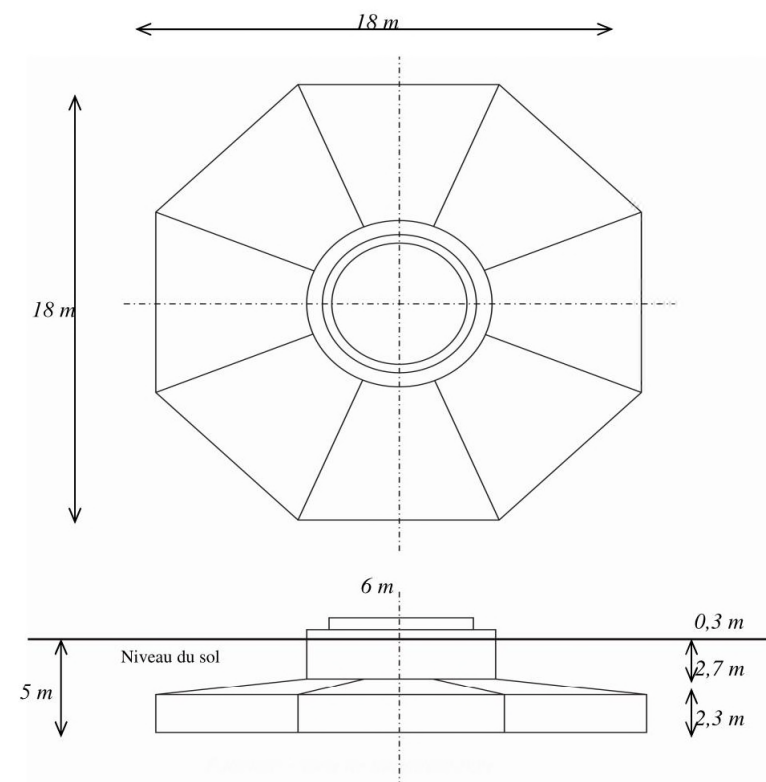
Schéma type d'une fondation (Source : Vestas)
